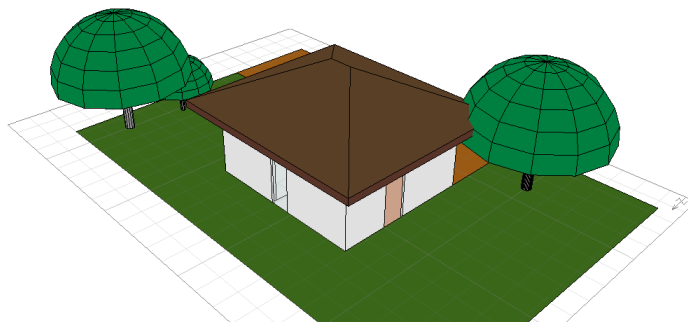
Tampak Depan Desain Baru Konsep Desain *Renovable
